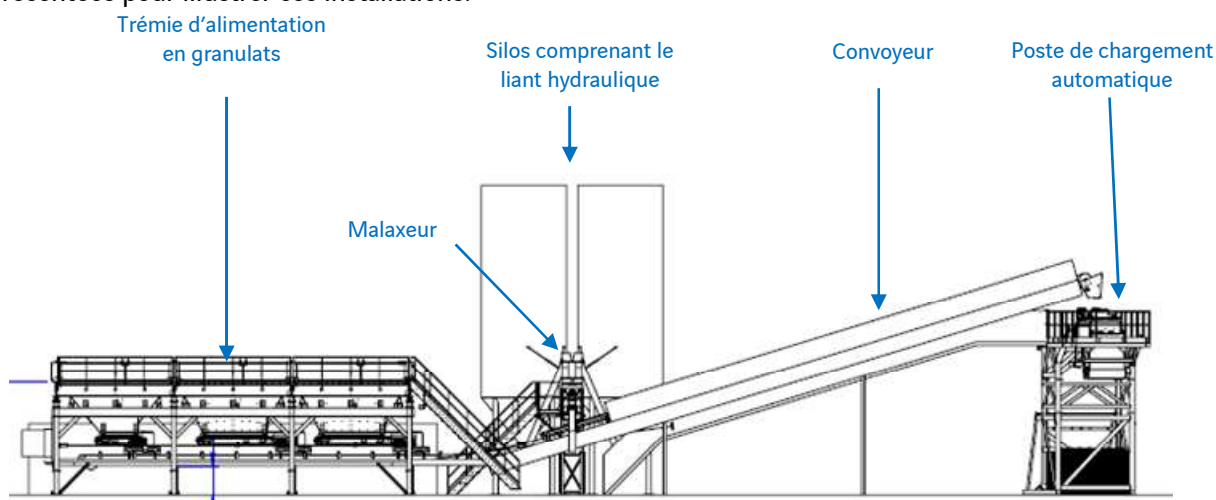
SCHEMA DE PRINCIPE EN COUPE LONGITUDINALE DE LA CENTRALE A BETON PRET A L'EMPLOI DE TYPE CENTRALE A GRAVE
